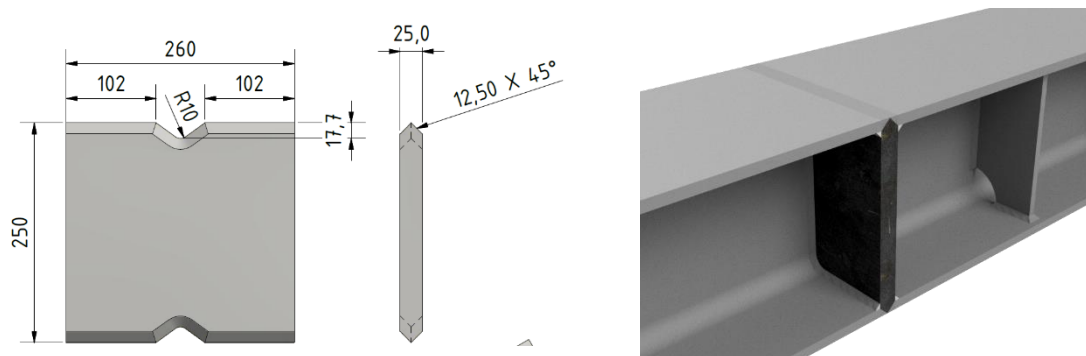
Schweißtechnische Instandsetzung des Probekörpers Nr. 1 – 2
